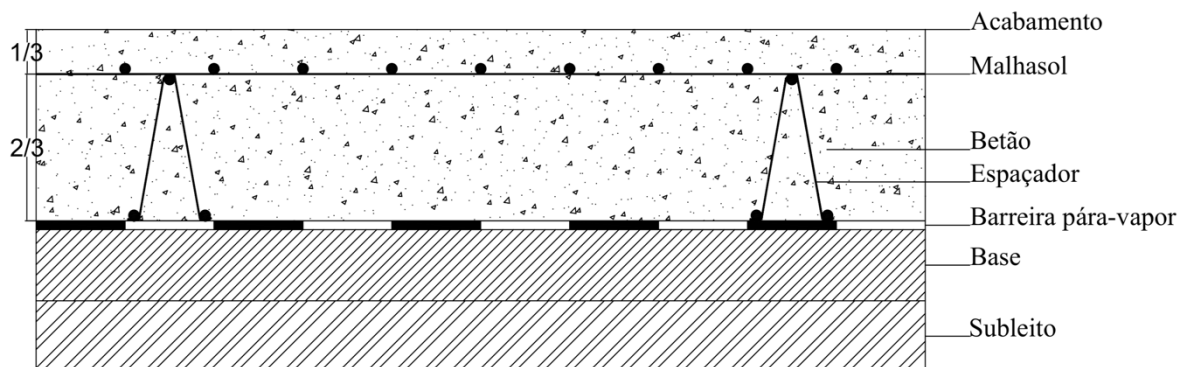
Pavimento de betão com armadura distribuída contínua [adaptado 34]
